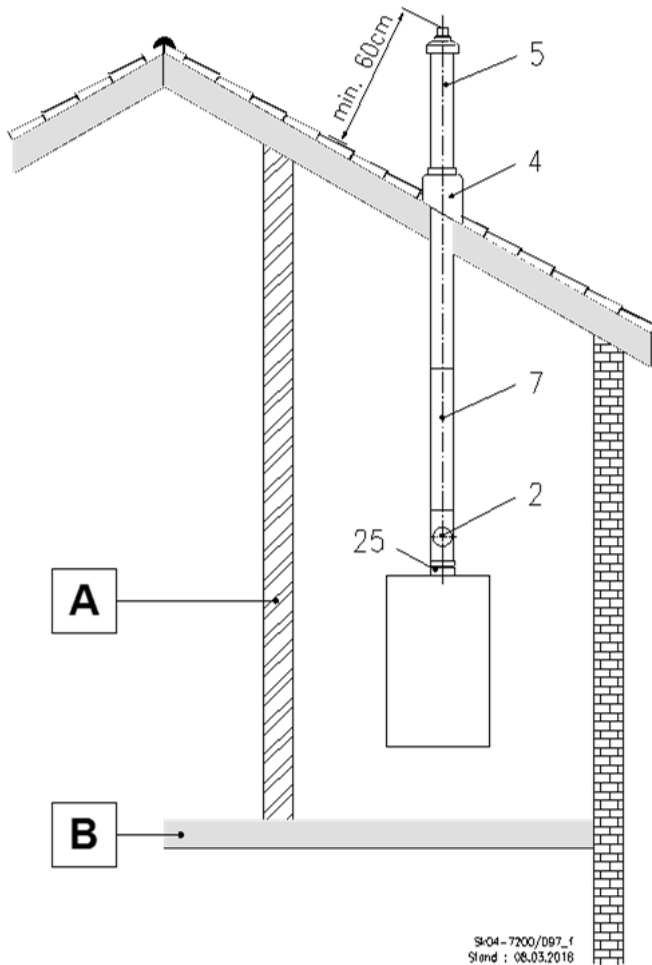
C<sub>33X</sub> Dachheizzentrale mit der Durchführung senkrecht durch ein Schrägdach
